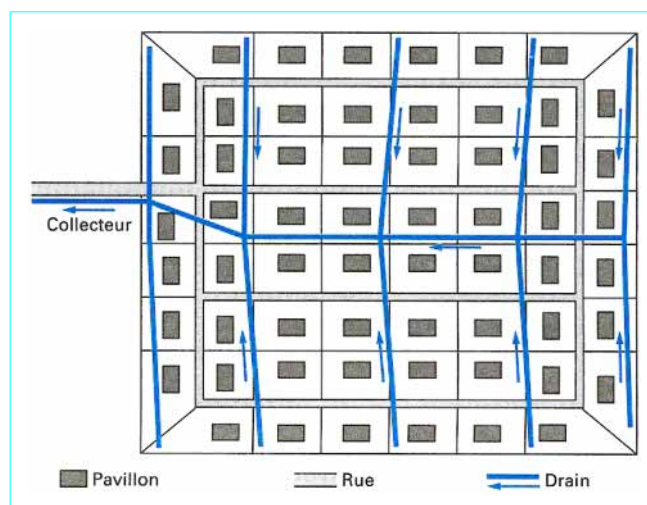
Exemple de drainage collectif d'un lotissement sur un terrain sensiblement plat
